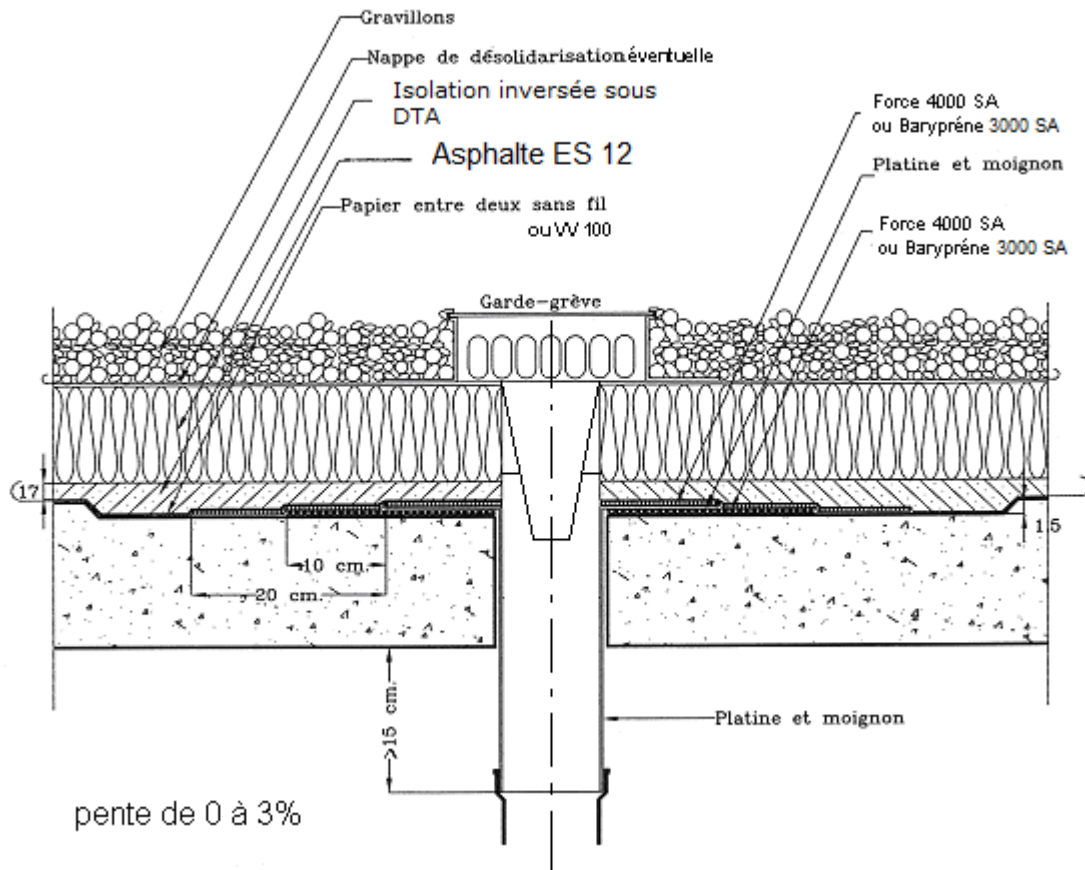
Raccordement aux EP - Terrasse inaccessible, protection par gravillons
